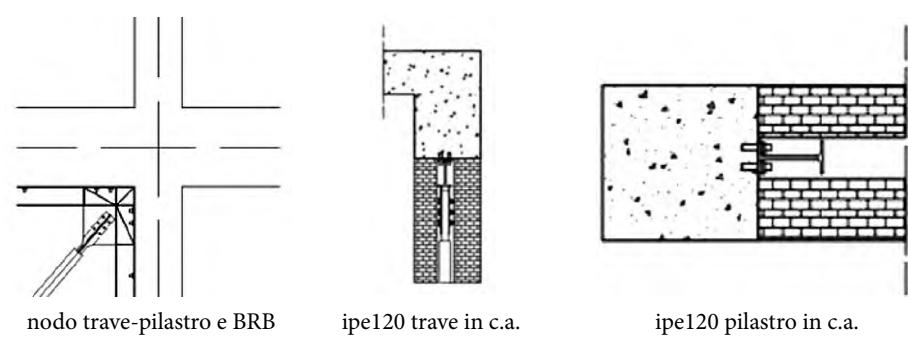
Dettagli dei collegamenti nell'intervento con BRB
